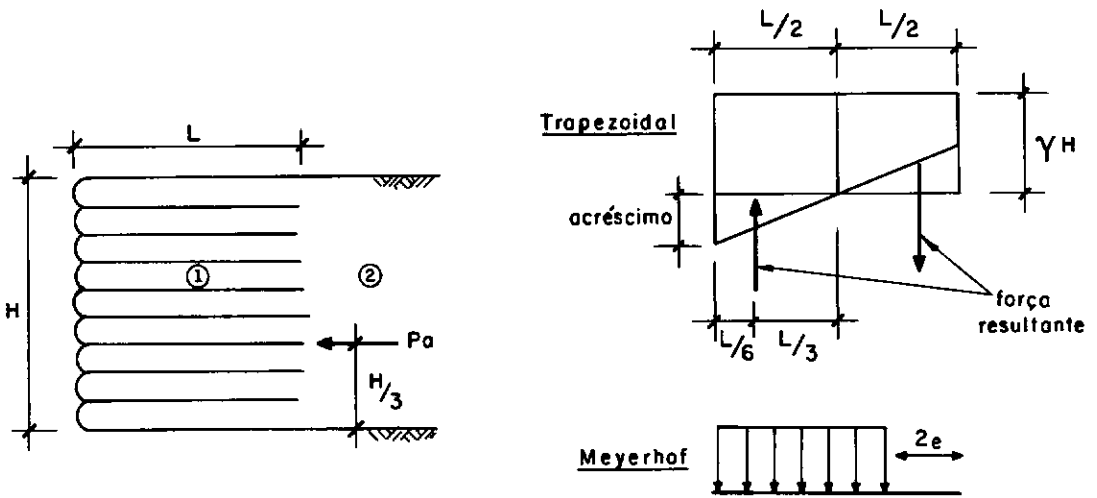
Distribuição de tensões verticais por Meyerhof e trapezoidal
